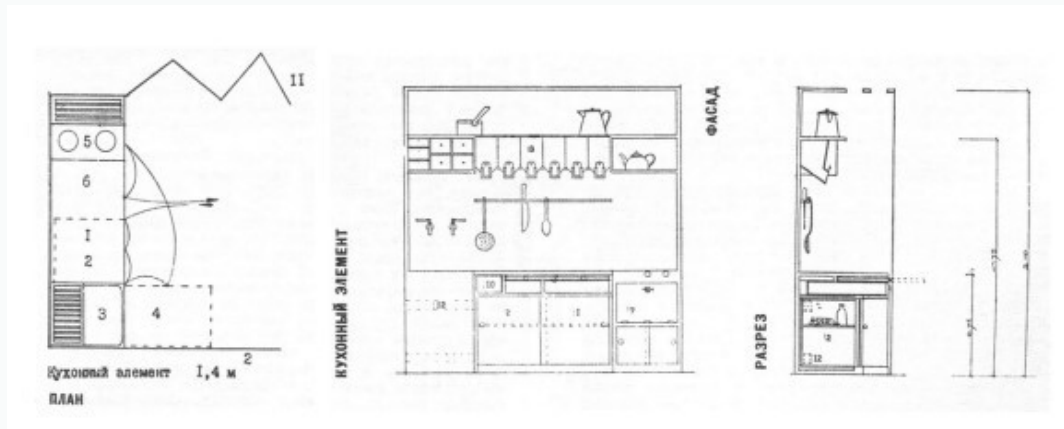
Planta, elevação e corte da cozinha-armário (1929).
